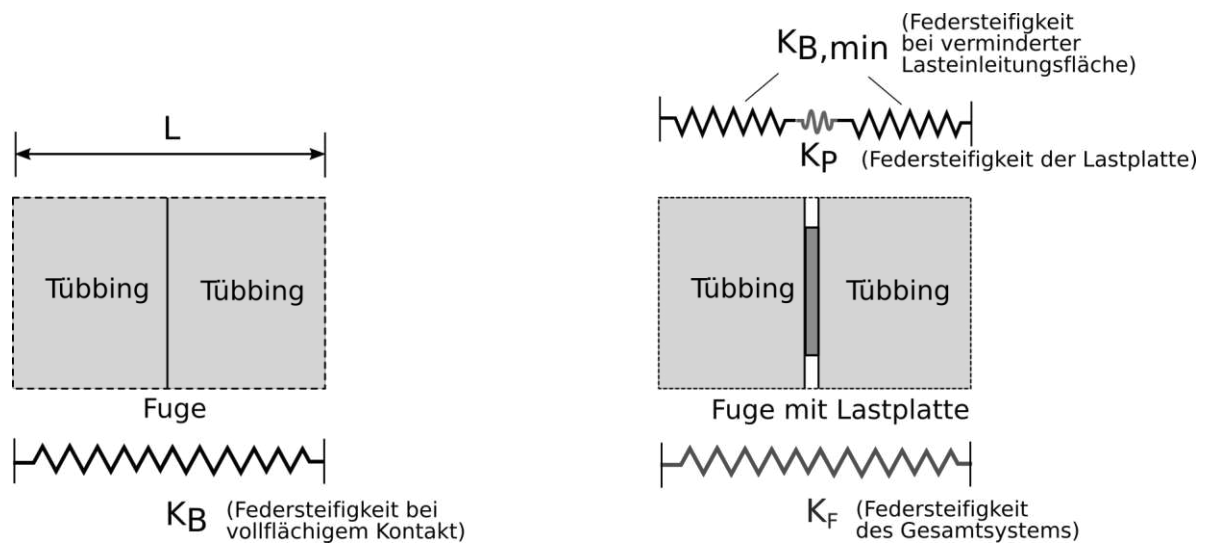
Ersatzsystem Beton-auf-Beton-Kontakt (links), Ersatzsystem mit Lastplatte (rechts)
